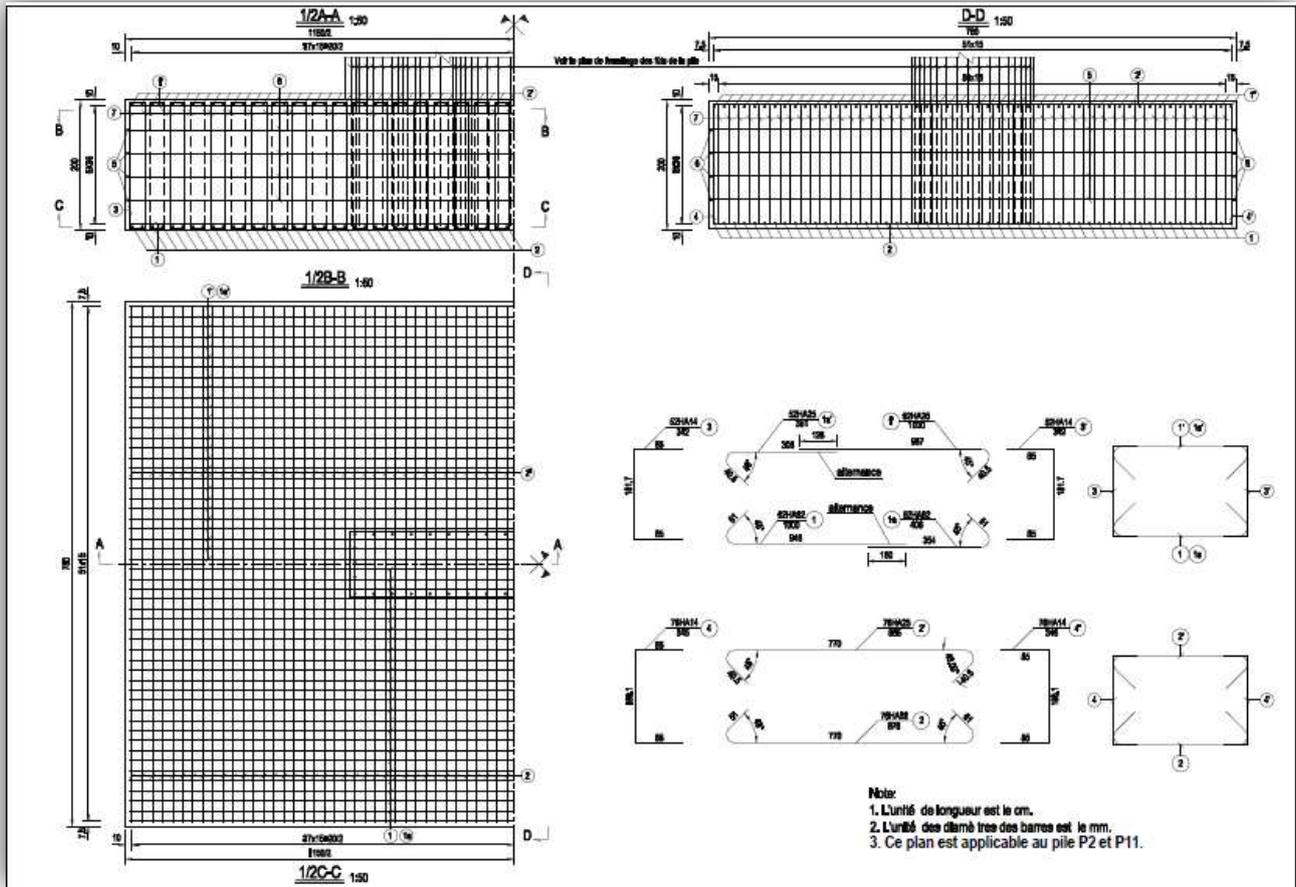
Détails du ferrailage des semelles des piles P2 et P11 [3]
